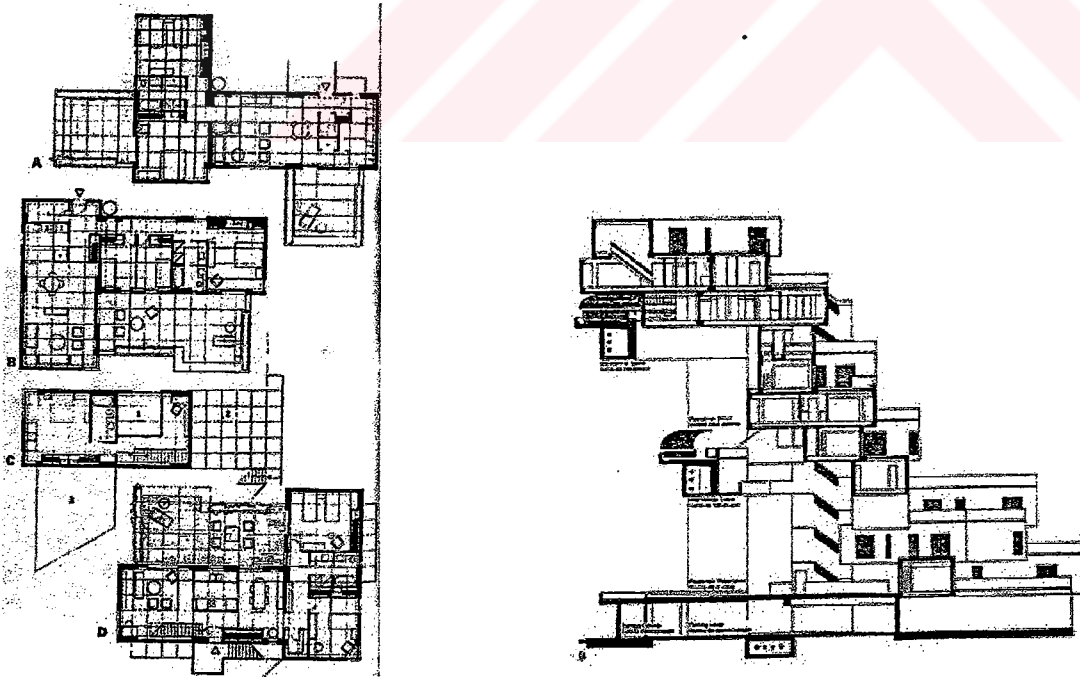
Byker Wall Yerleşmesi. Konut grupları plan ve kesitleri.
